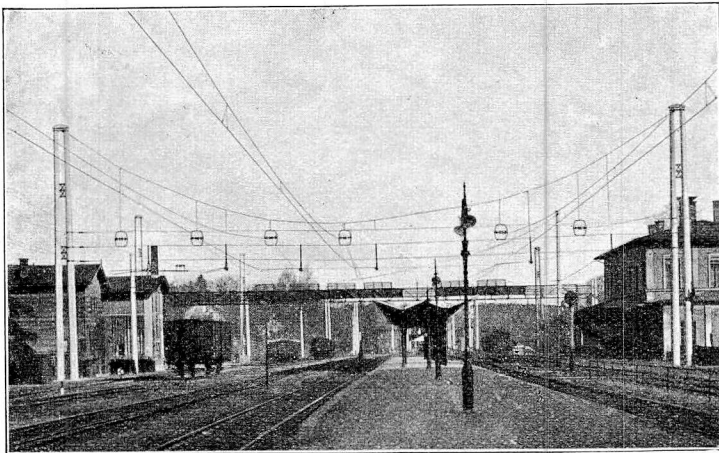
Schleuderbetonmaste in Bahnhöfen.
